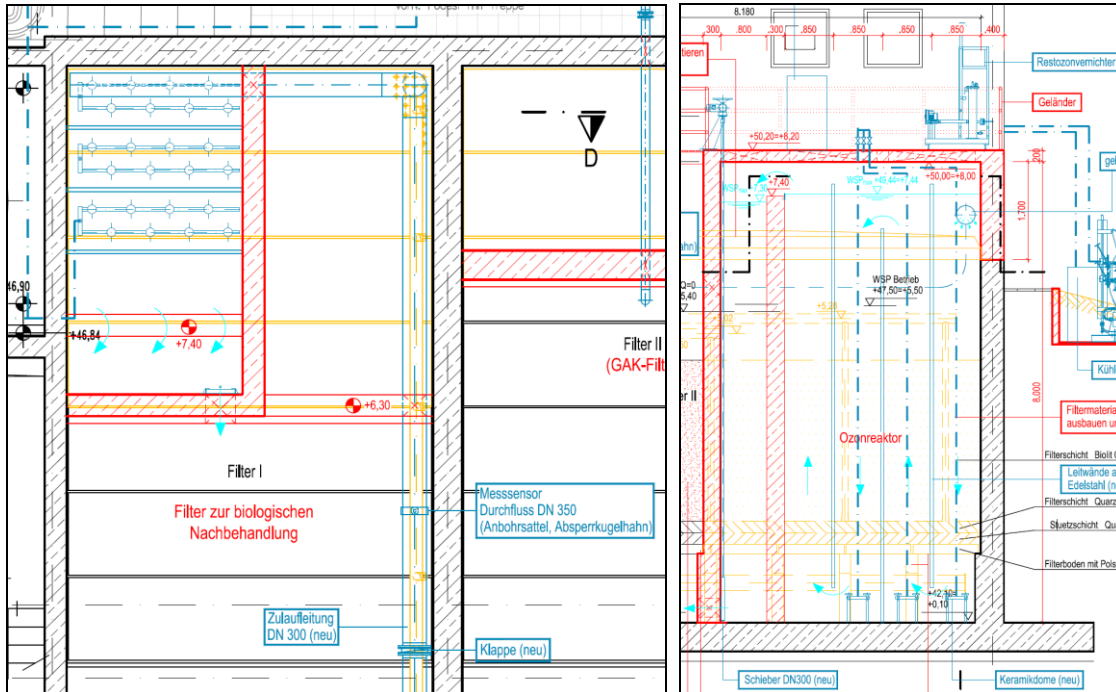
Grundriss (links) und Längsschnitt (rechts) des Ozonreaktors
